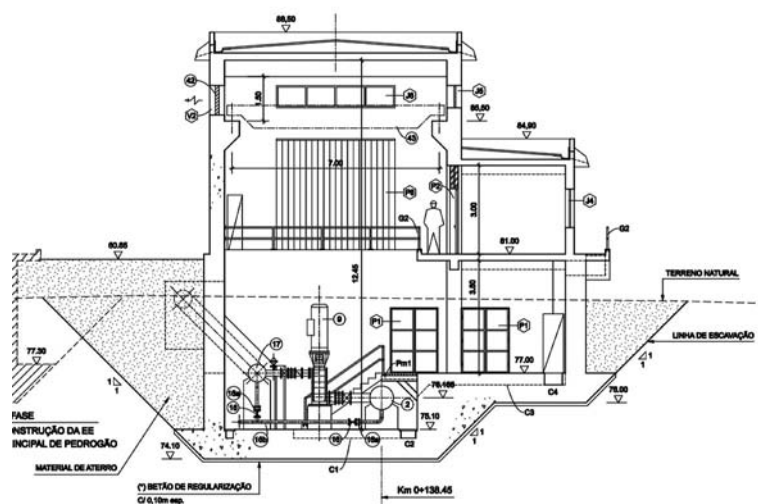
Estação Elevatória de Pedrógão 1. Corte Transversal
